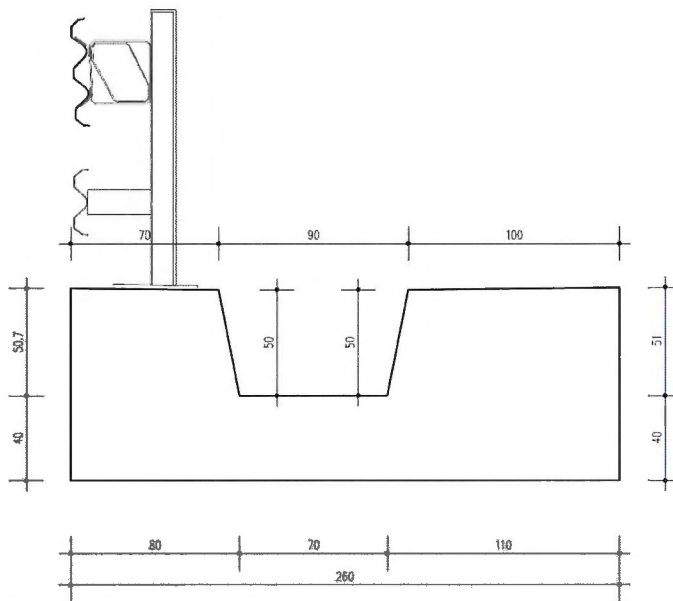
Sezione Tipo A (Barriera lato Sud) – Tratto 2
